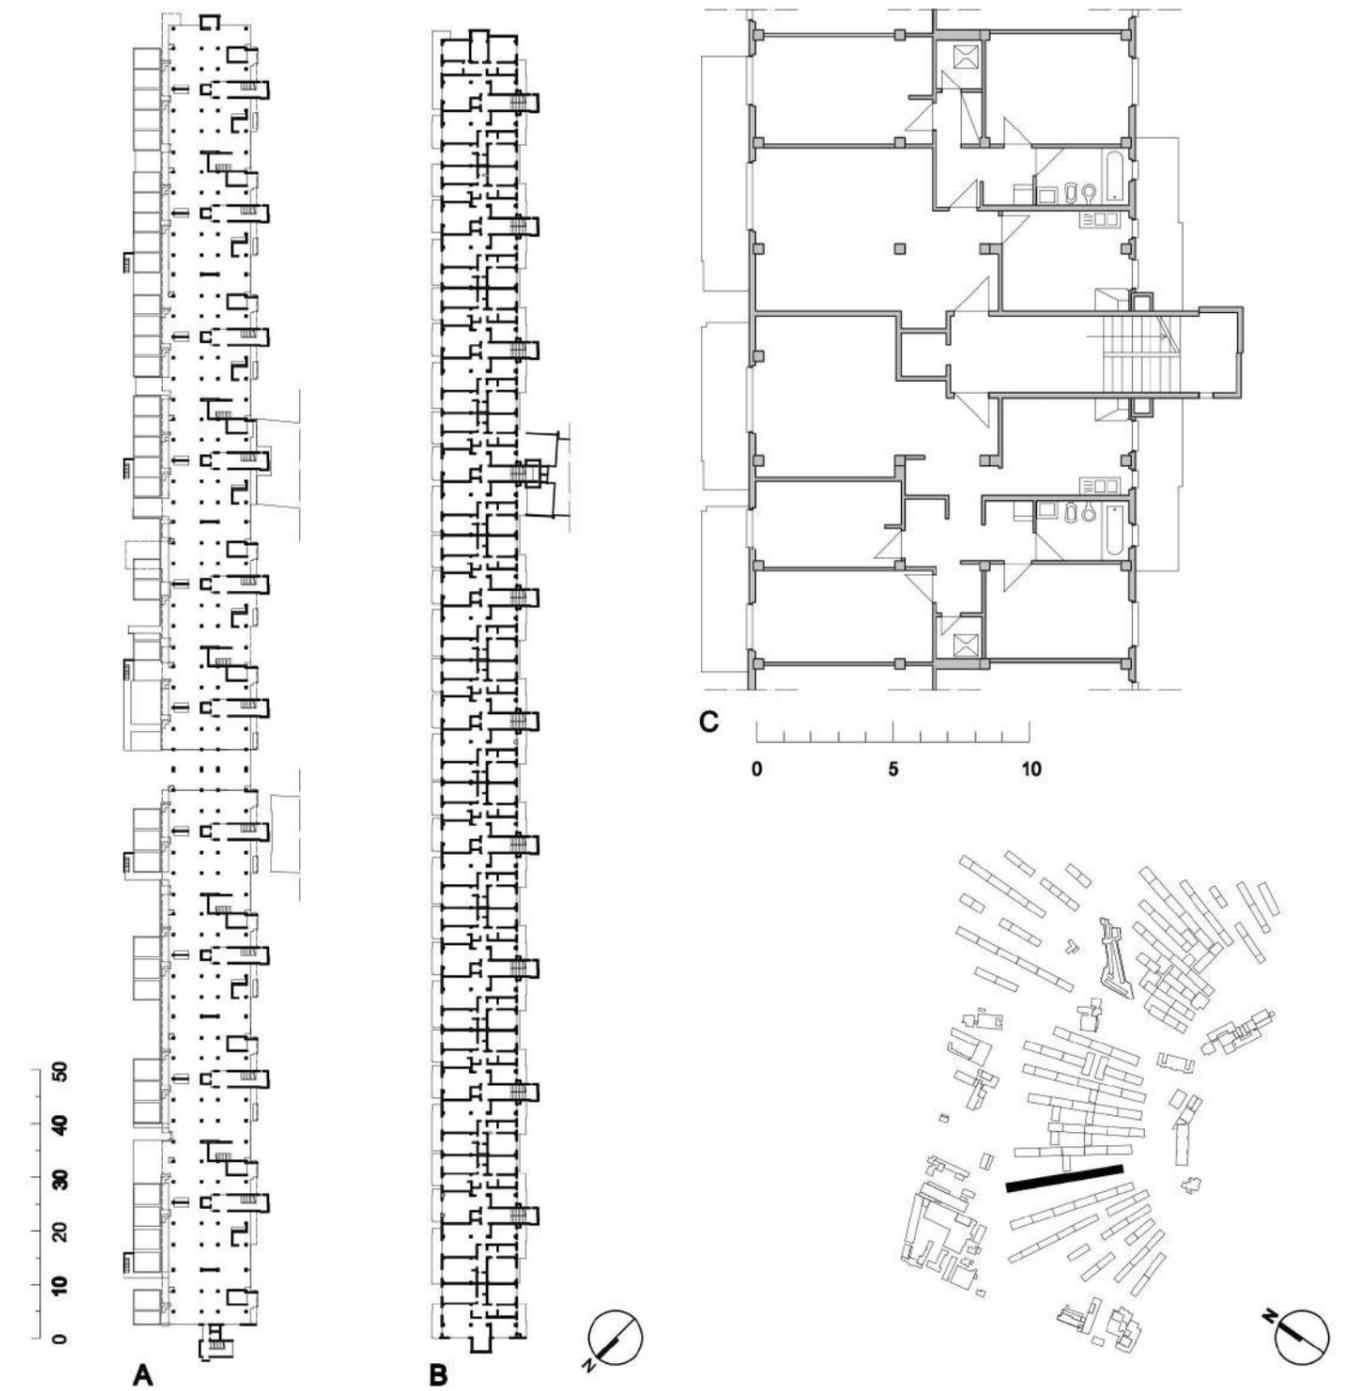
Piano di zona Casilino 23, progetto edificio "T8"; A - edificio in linea, pianta piano terra; B - pianta piano tipo; C - pianta appartamenti
